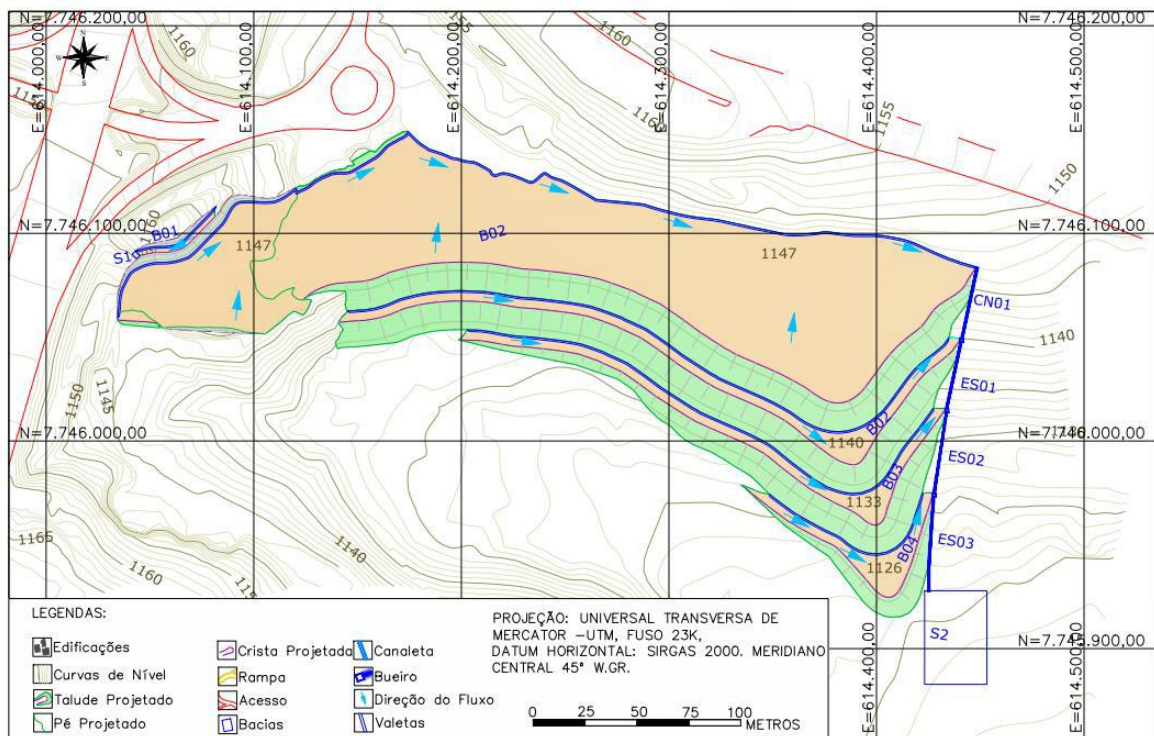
Layout do projeto de drenagem da Pilha Trevo.
